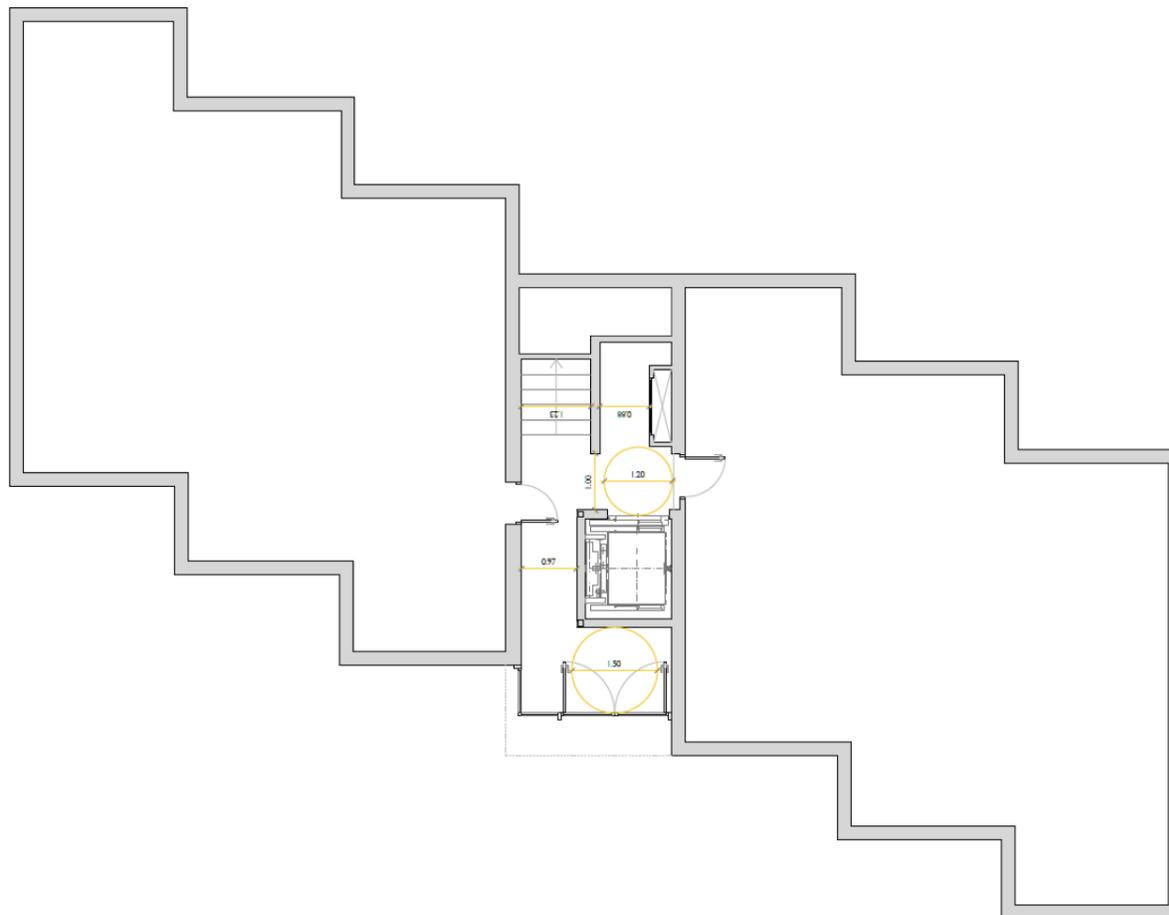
Plano zaguán. Planta semisótano. OPCIÓN 1
